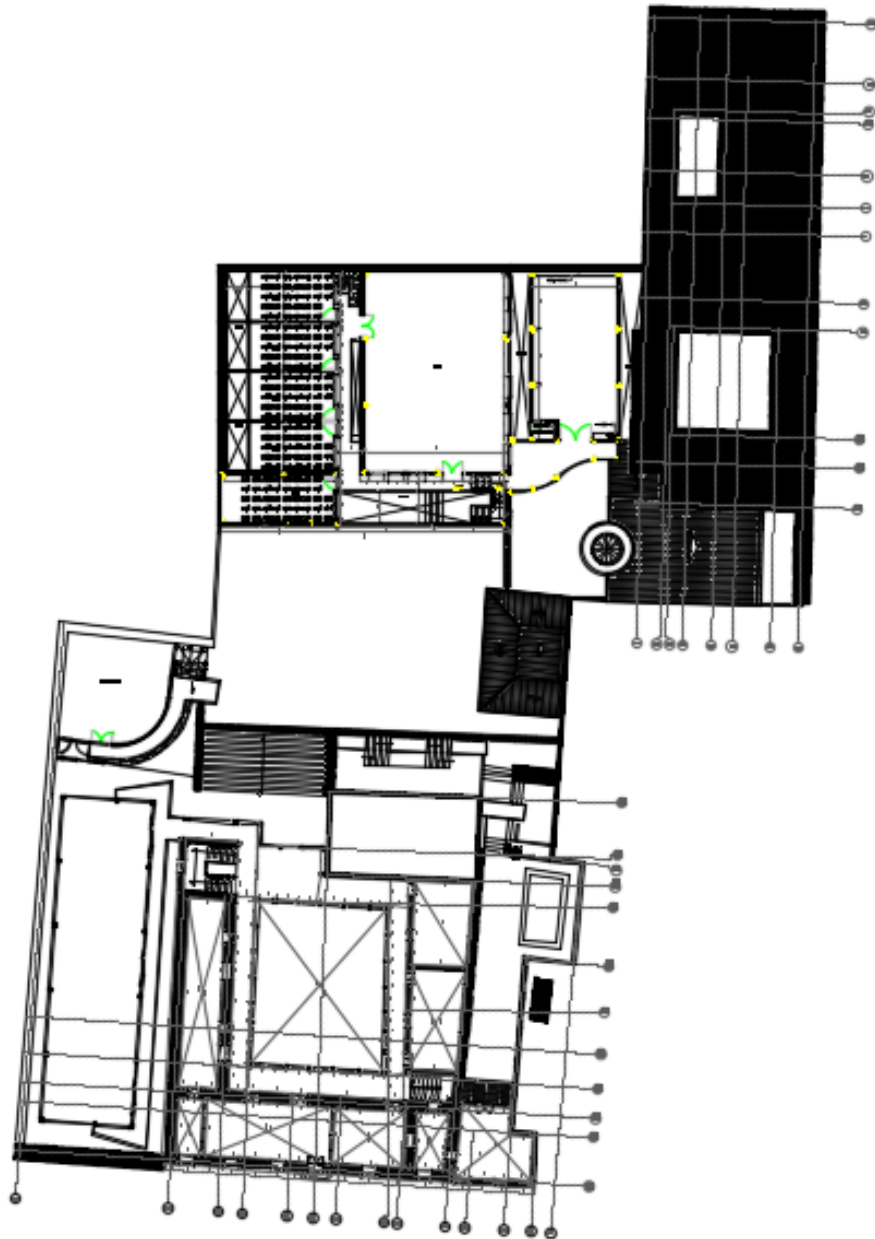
, vista planta arquitectónica de la Casona (2 planta), fuente: Autor propio, 2016.
